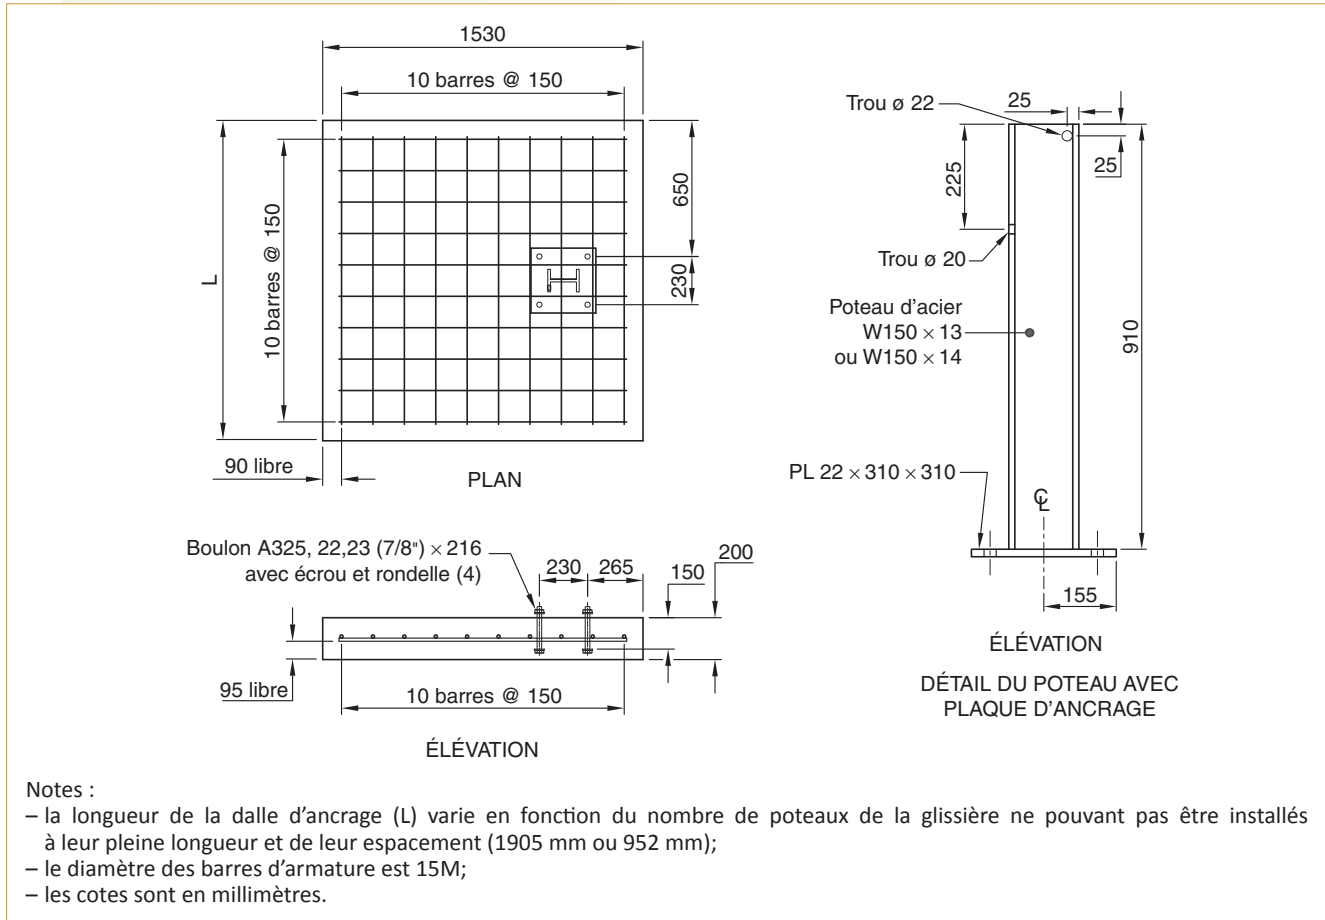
Détail de la dalle en béton armé et du poteau d'acier
